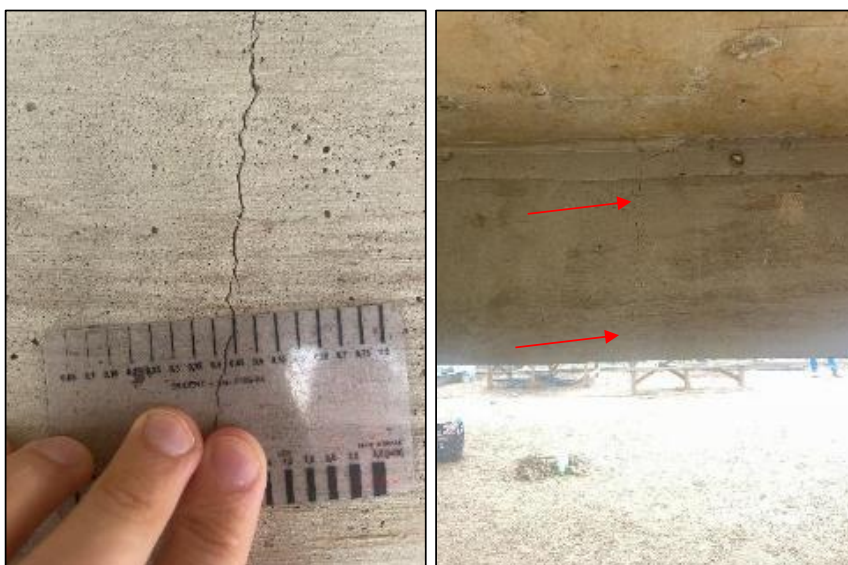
Fissura identificada na viga de concreto da estrutura da nova ETA (foto data: 06/06/2023).
